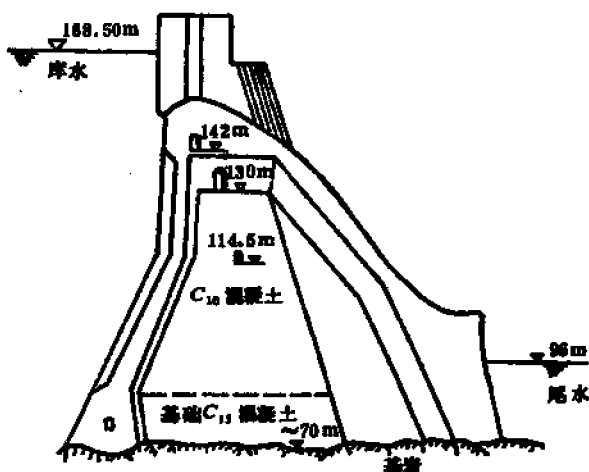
(4) 重力式大体积混凝土加固体横剖面图
